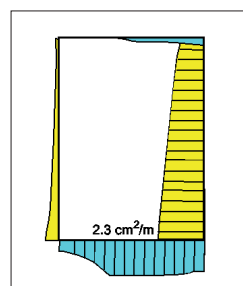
Hauptmembrankräfte in der Seitenwand sowie Horizontalbewehrung an der Einspannstelle
